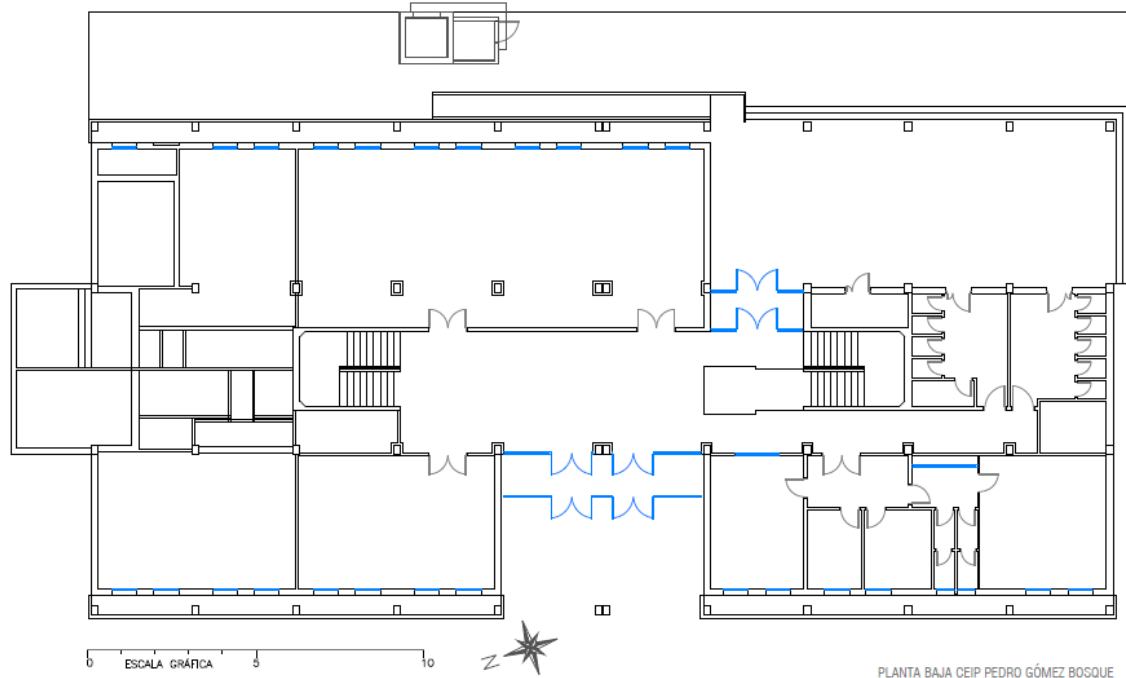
Planta baja del CEIP Pedro Gómez Bosque. Fuente: Archivo Histórico Provincial.
